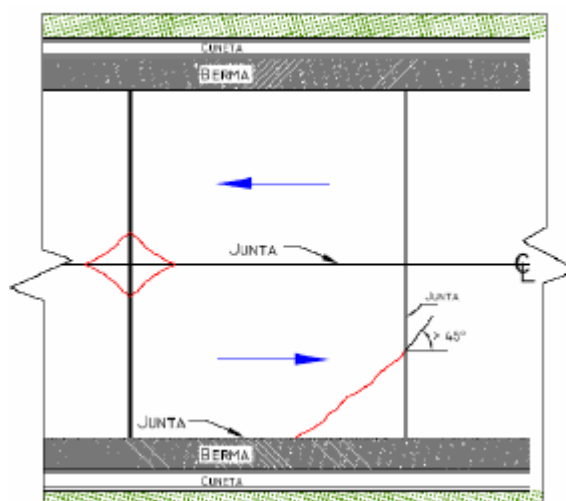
Vista en planta de grieta (GE)(INVIAS, 2006).
